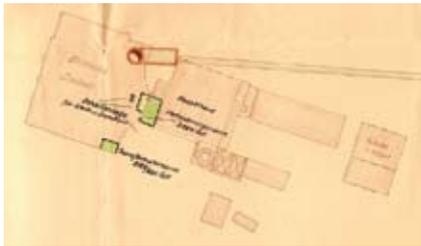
1925 nachgerüstete Elektroanlagen. Bergarchiv Clausthal unten mit Kreuzen: die beiden Kohlebunker, darunter das größere Gebäude: Umspannwerk 1, rechts daneben: ein Wohnhaus
